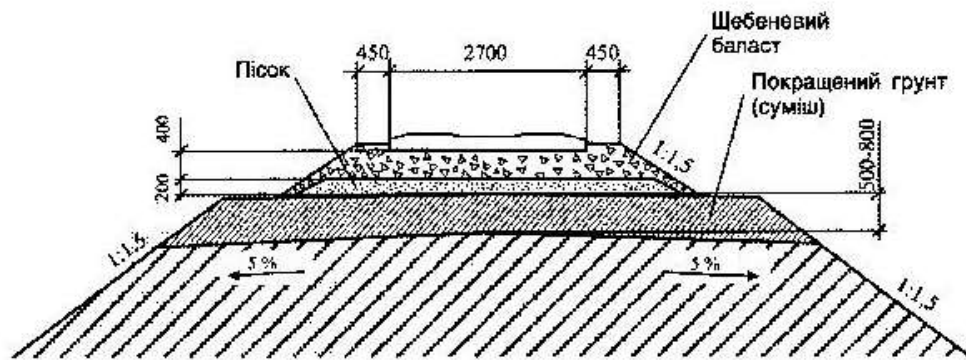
Конструкція земляного полотна типу 6-1 з конструктивним захисним шаром із стабілізованого ґрунту
